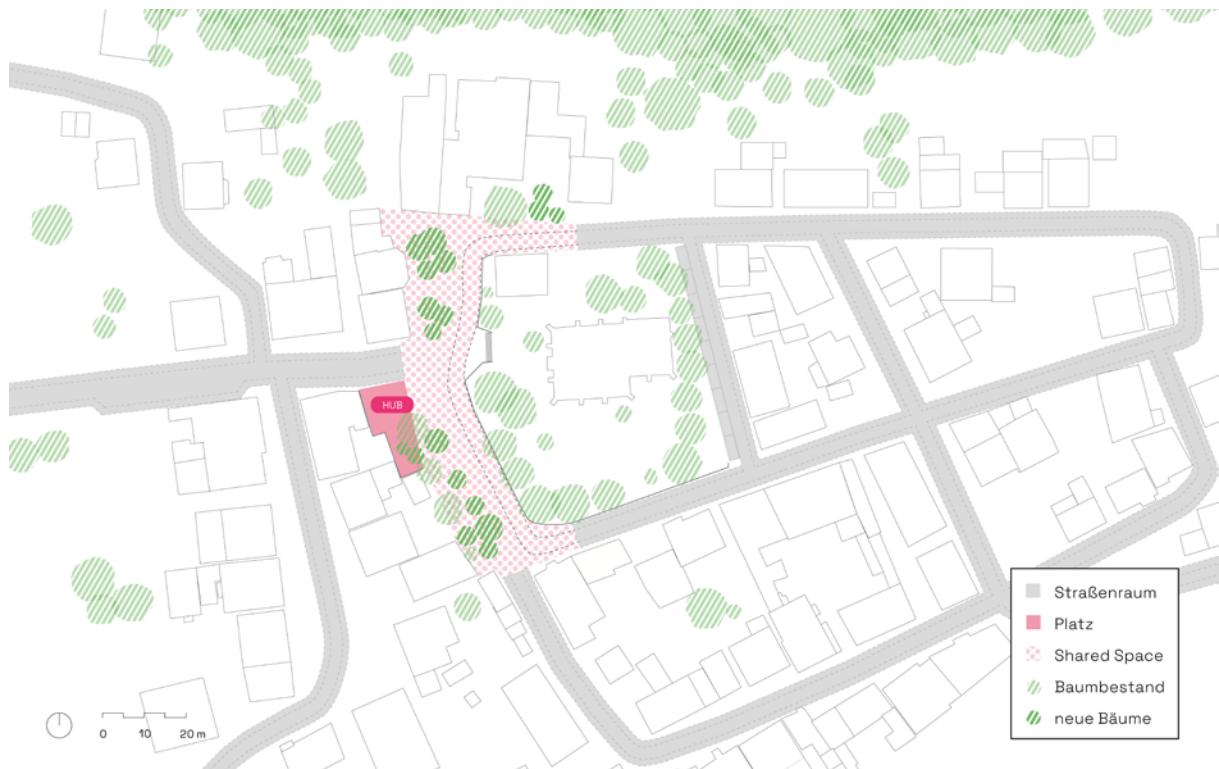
Lageplan Hub-Standort Trendelburg Rathaus/Kirche mit Neukonzeption
